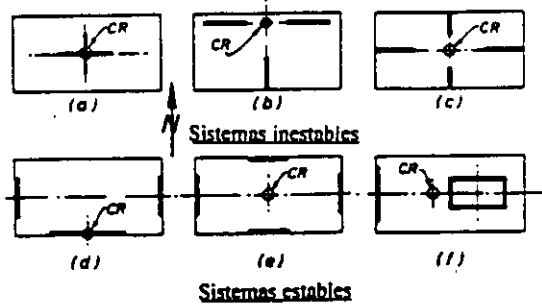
Ejemplos de estabilidad torsional en sistemas de muros estructurales
